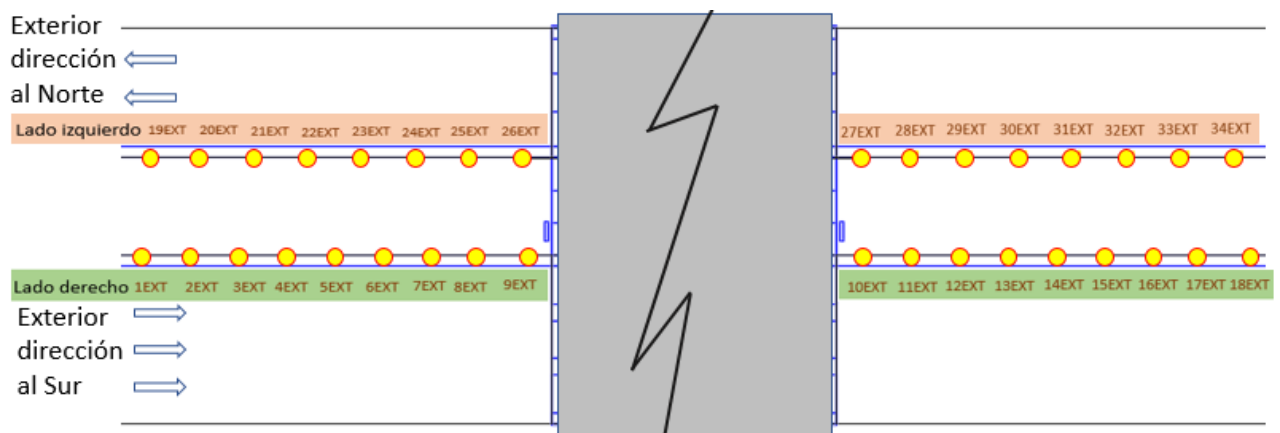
Distribución de LED- BGP322 t35 (luminarias exteriores del túnel con su respectiva numeración - Vista planta
